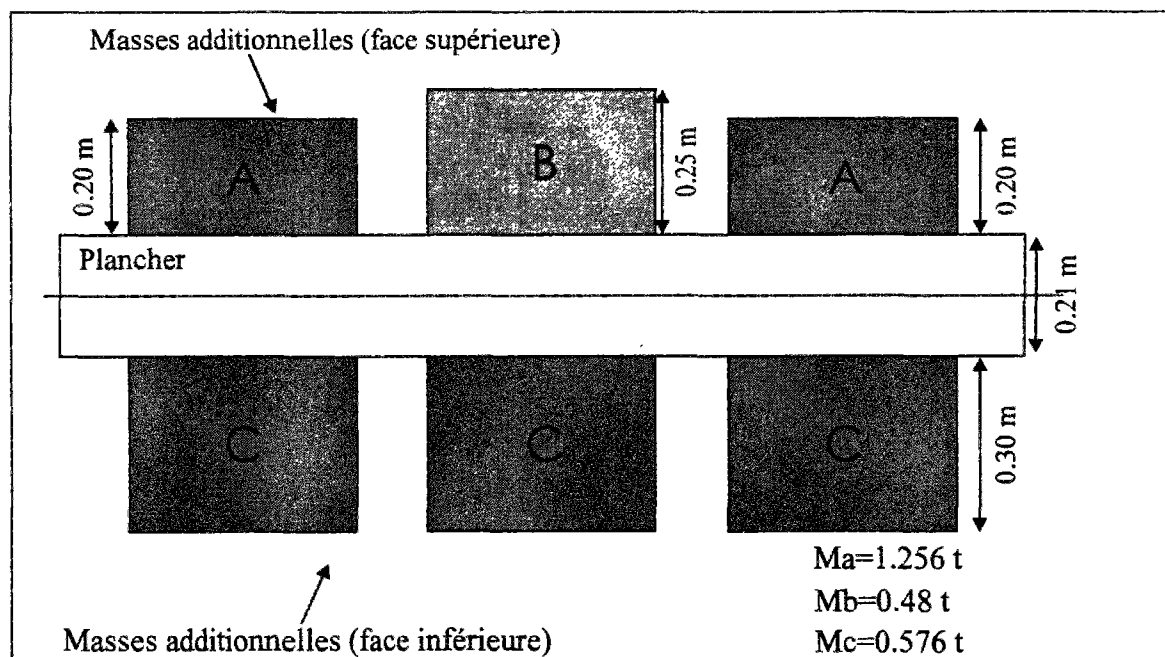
Plancher avec prise en compte des masses additionnelles
